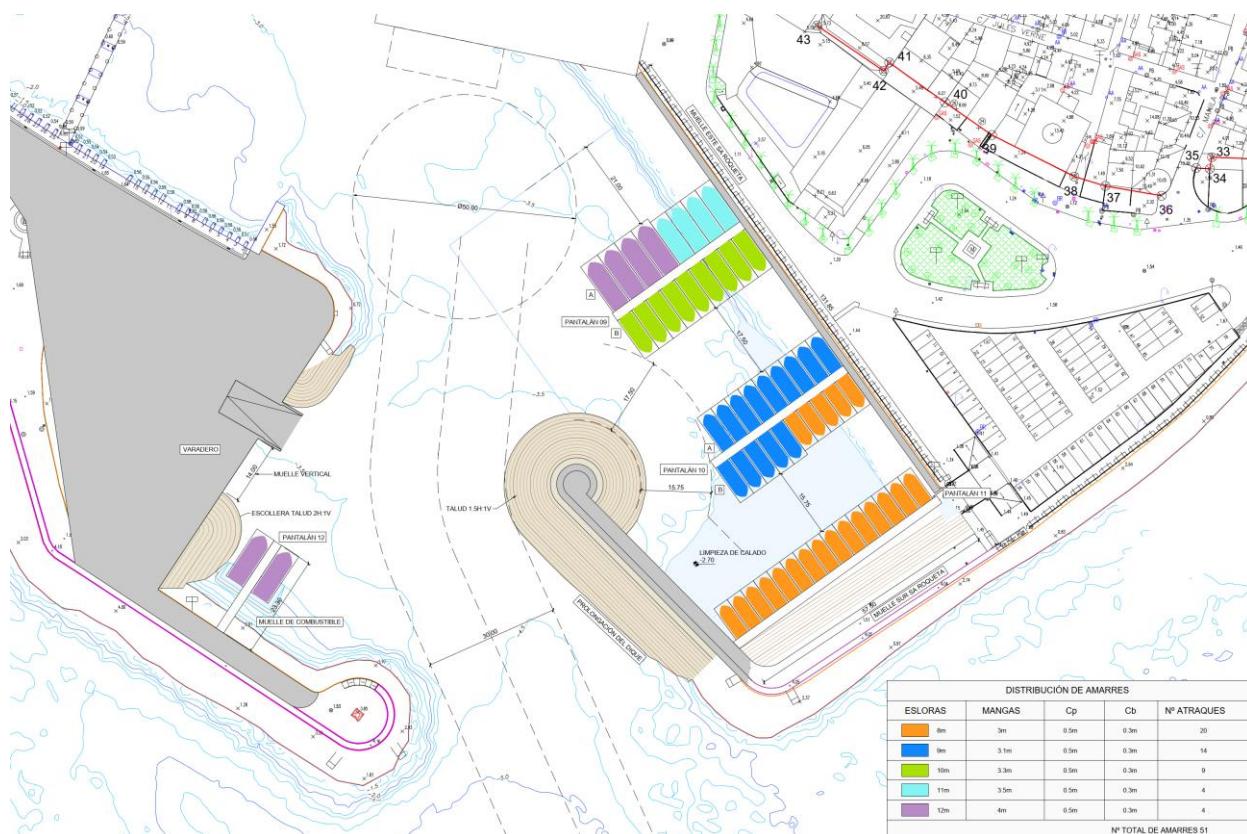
Resguardos existentes en la bocana interior y exterior. Fuente: TYPSPA
